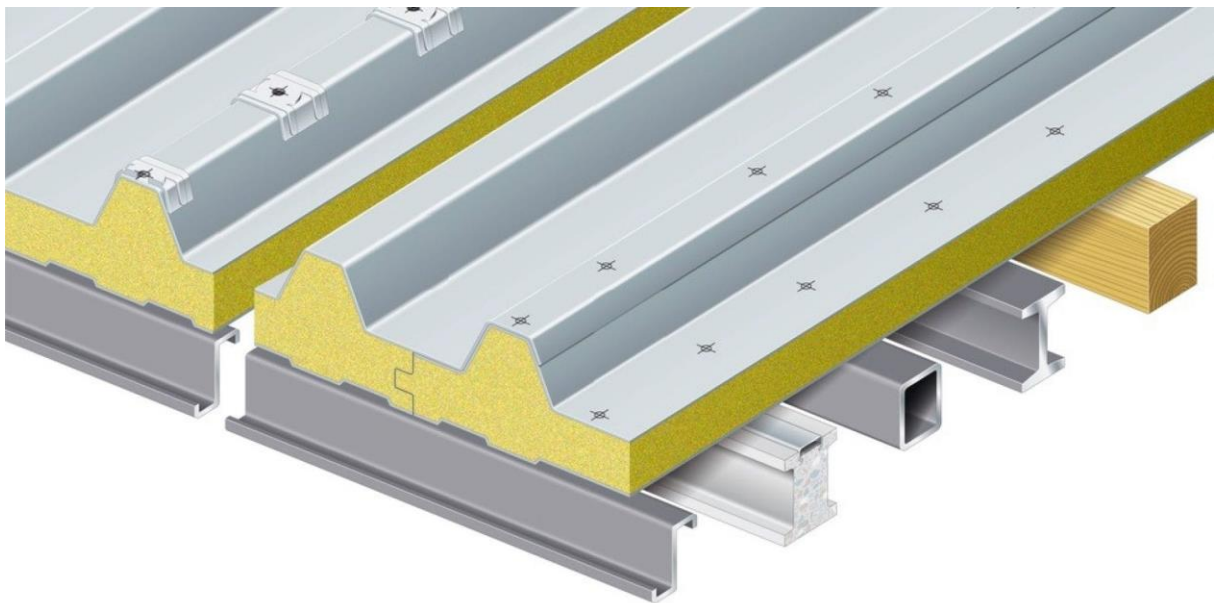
Painel sandwich, neste caso uma telha sandwich usada na indústria da construção civil
